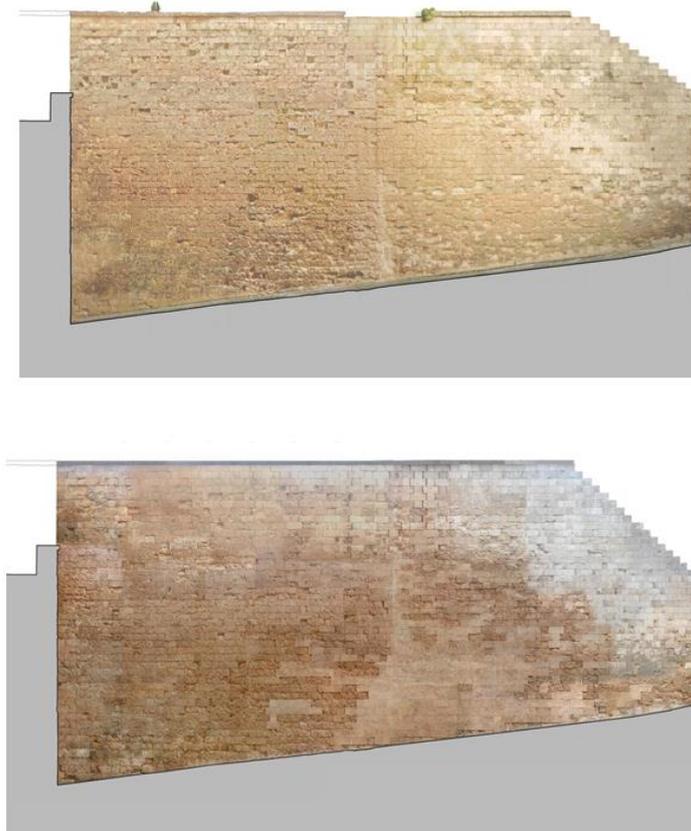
Fotoplano alzado Entrante 5, estado previo y estado posterior a la intervención. Fotografía: autores del texto.
